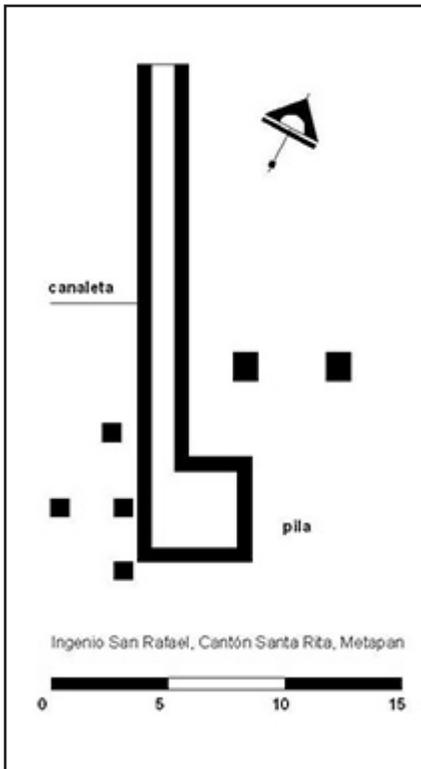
Vista de planta de los restos del Ingenio San Rafael, Metapán, Santa Ana.
